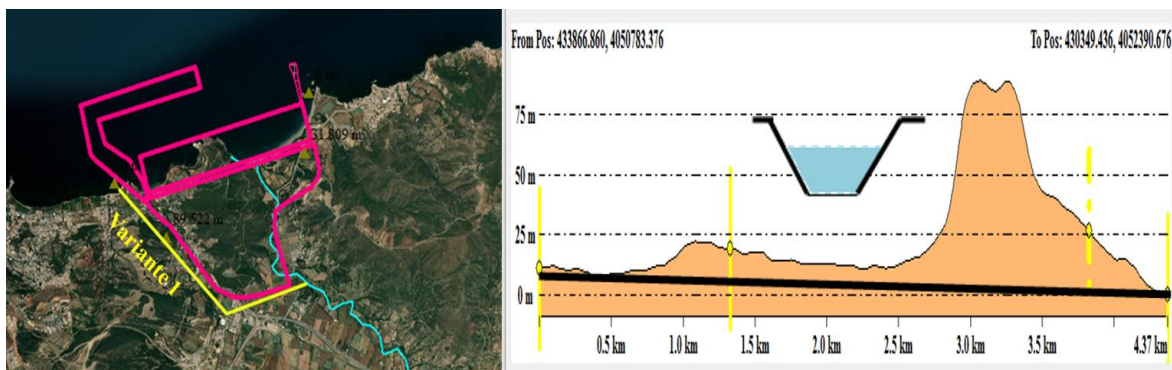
Vue en plan, profil en long et section en travers de la variante 1
